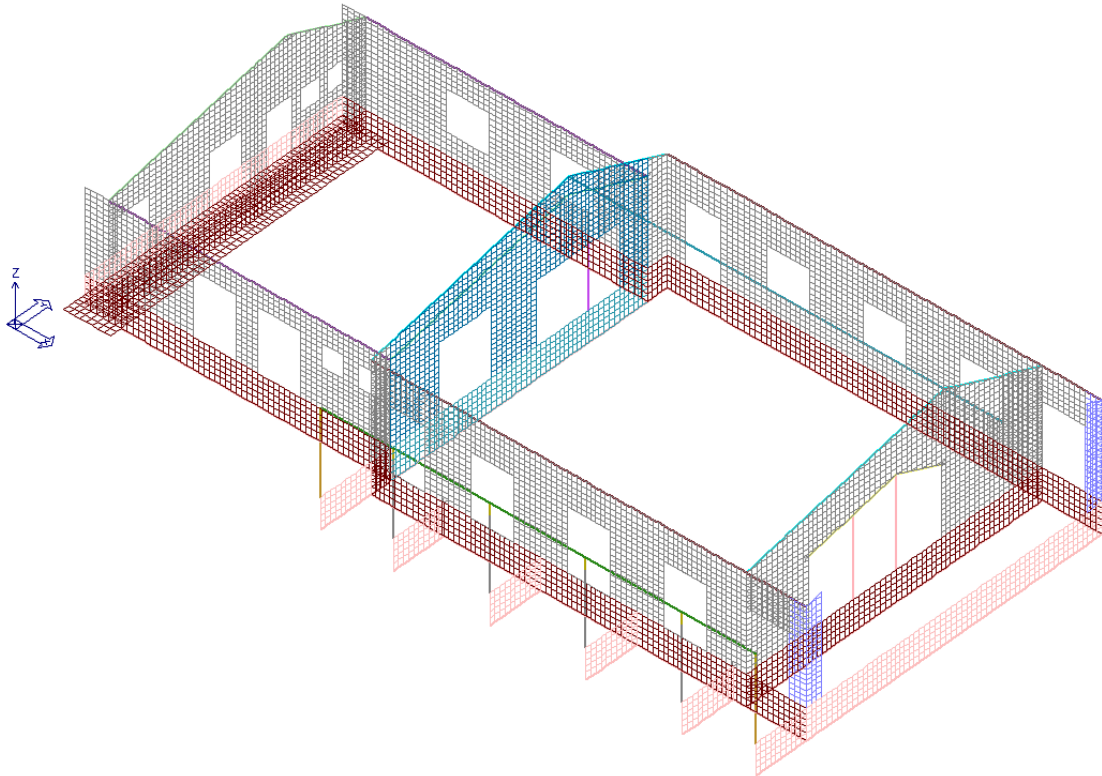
Modello Strutturale Vista unifilare- vista assometrica 1.
